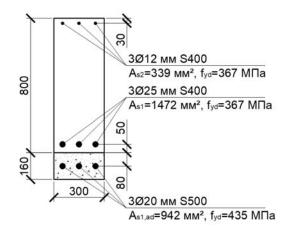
Поперечное сечение железобетонной балки (к решению примера)
